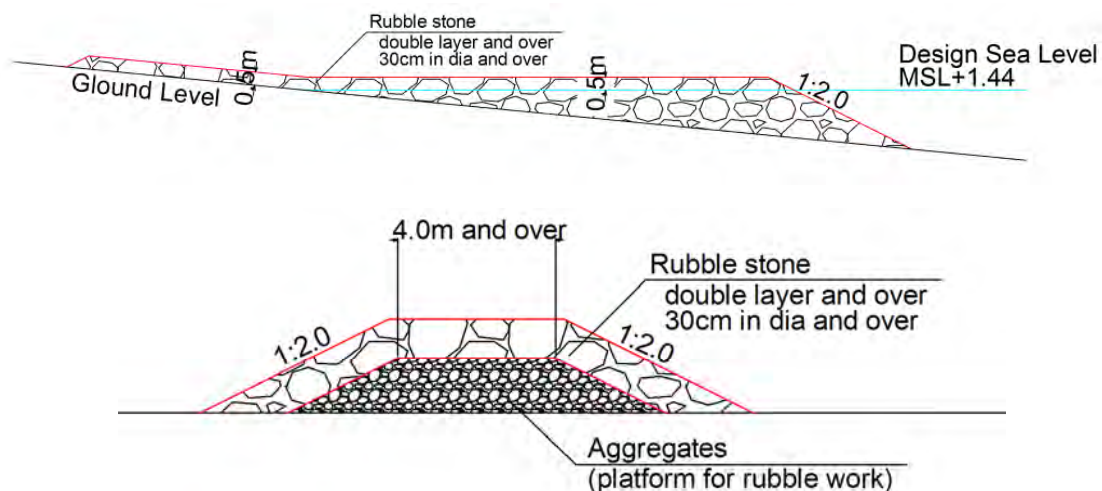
ラ・パッセ突堤の縦断面図と横断面図
